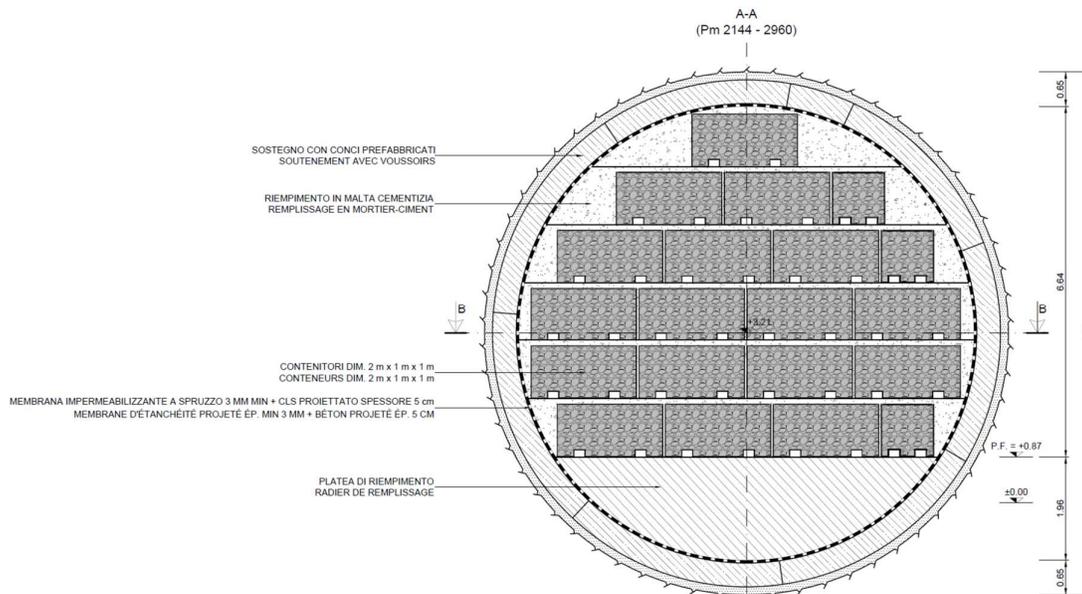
Sezione di stoccaggio nella sezione corrente di Maddalena 2 (PRV\_C3A\_7533\_26-48-11)
